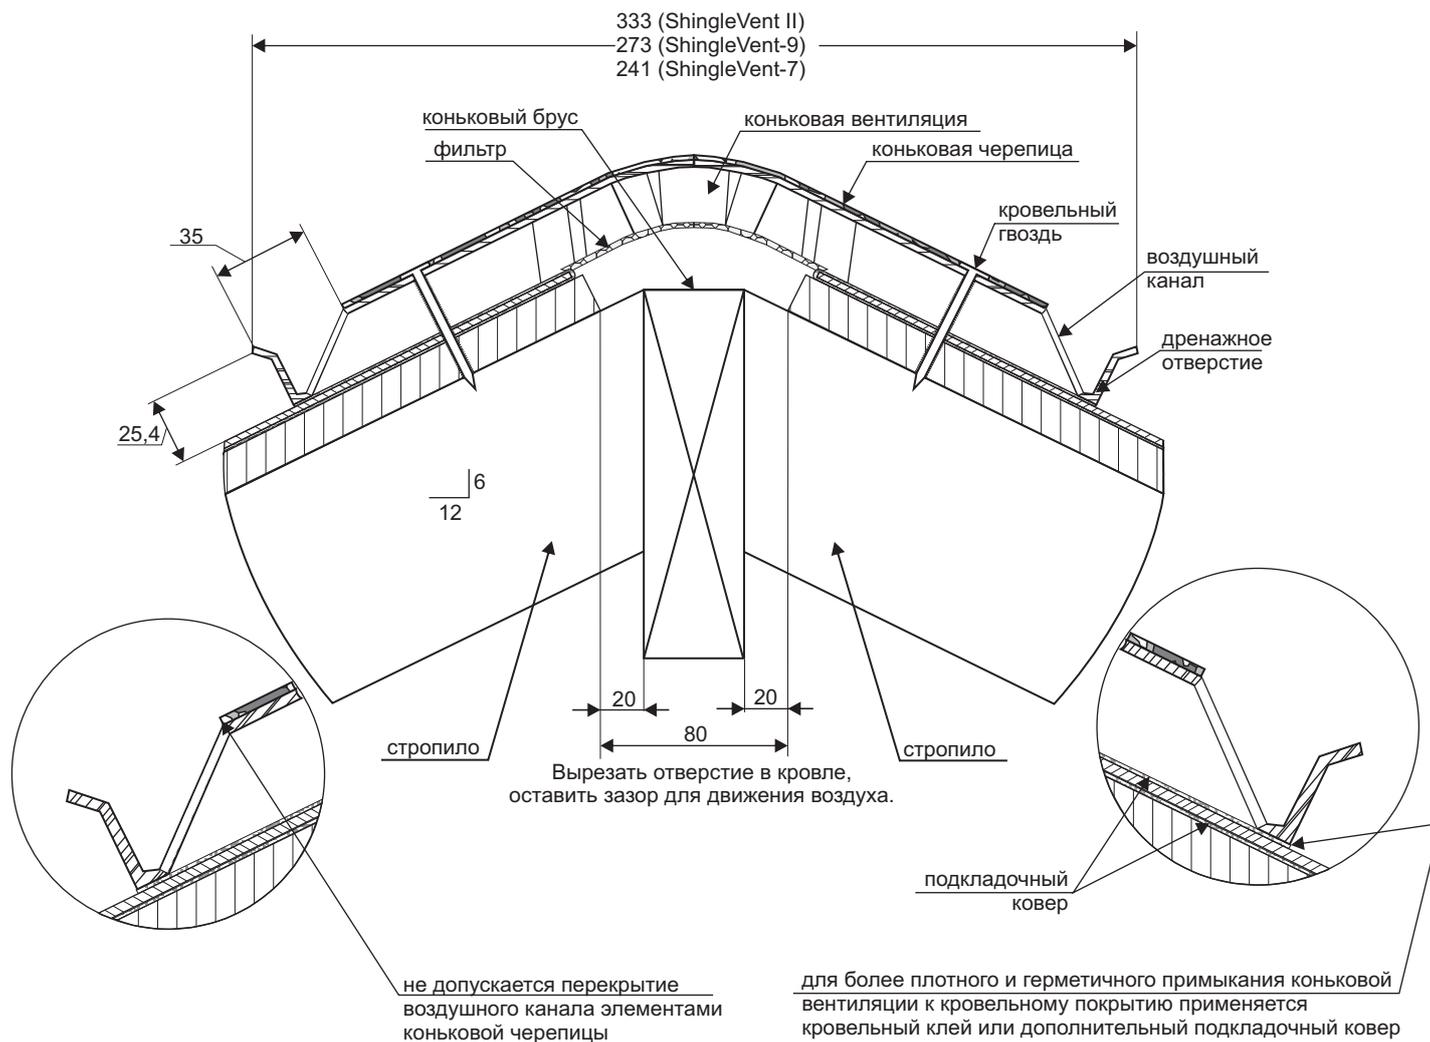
Крыша из стропильных ферм с коньковым брусом
